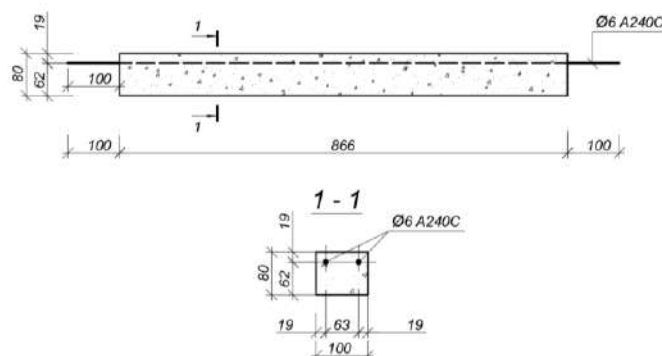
Опалубочне креслення залізобетонного вкладиша
